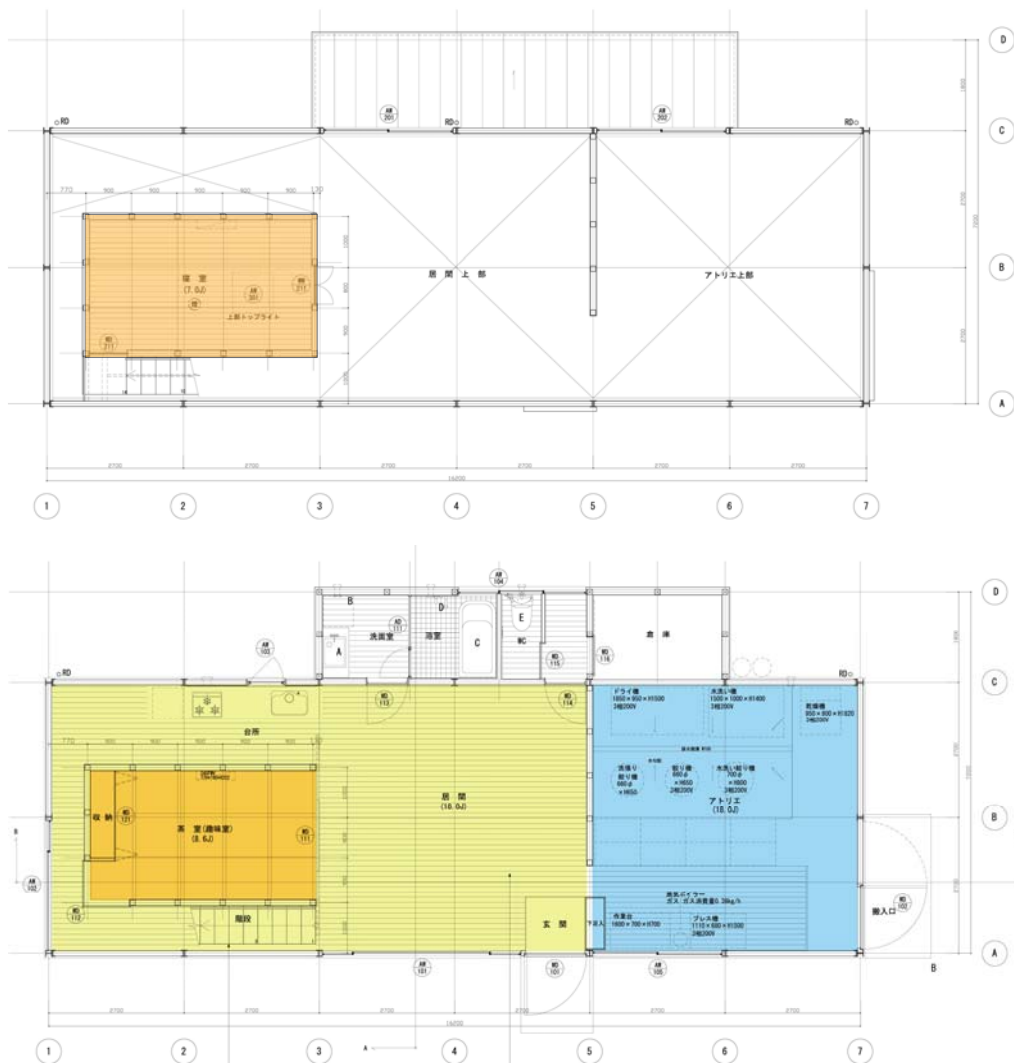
平面計画 上: 2階平面図/下: 1階平面図 オレンジ部分が入れ箱の居室
